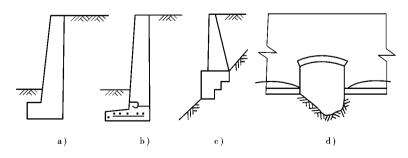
挡土墙基础形式 a)扩大基础 b)钢筋混凝土底板 定)台阶形基础 zl)拱形基础(纵断面)
